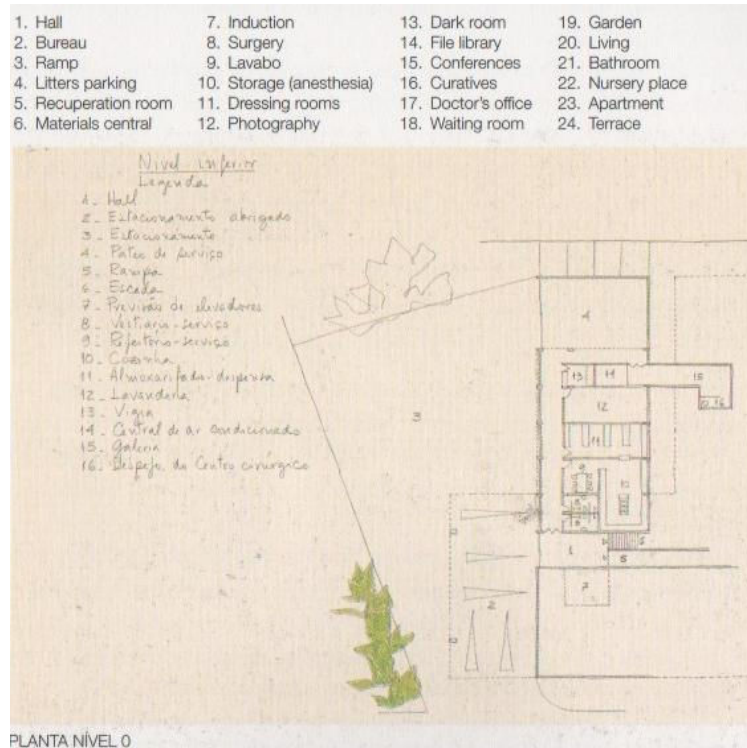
Planta baixa - subsolo (LATORRACA, 1999).
